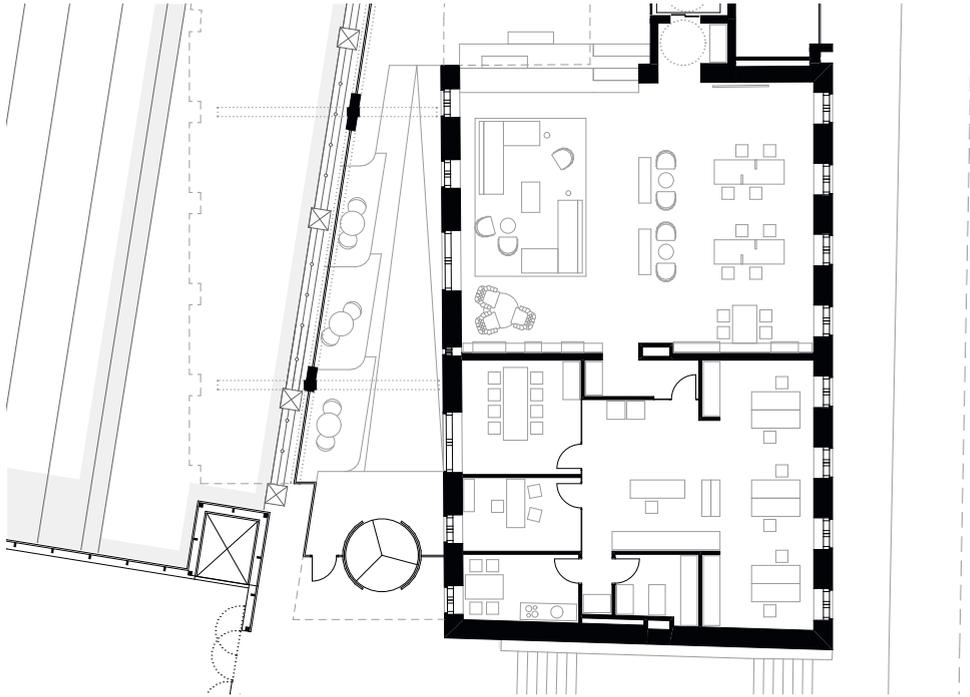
; Ausschnitt, Erdgeschoss, 1:250
